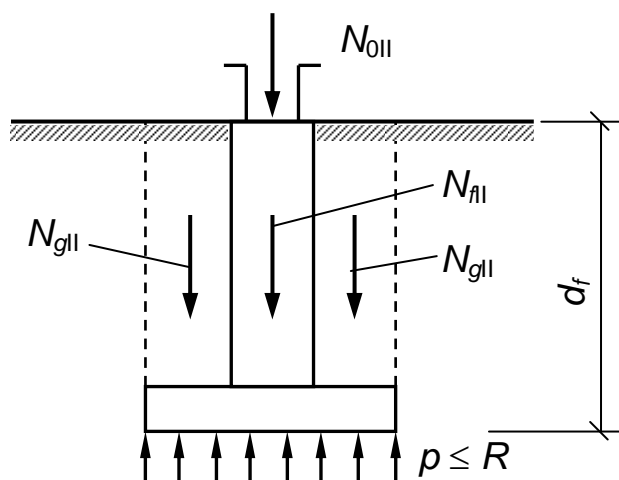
Расчетная схема центрально нагруженного фундамента
